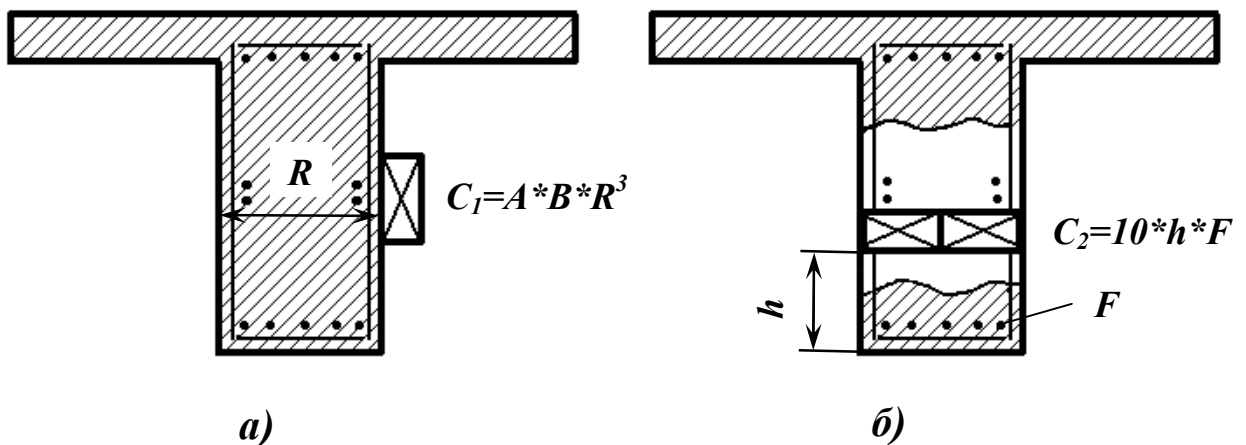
Роздільне (послідовне) підривання бетону й арматури:
